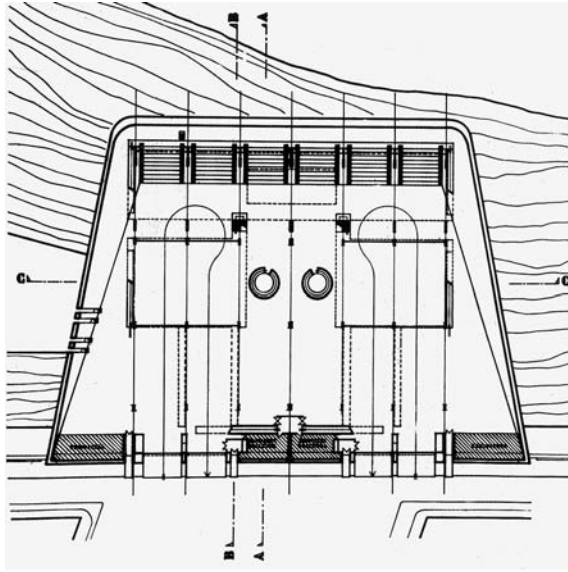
Claude Parent und Paul Virilio/Architecture Principe, Palais des expositions de Charleville, Frankreich, Entwurf 1966/67. Grundriss des Erdgeschosses, Tinte auf Transparentpapier, 74 x 107 cm.
